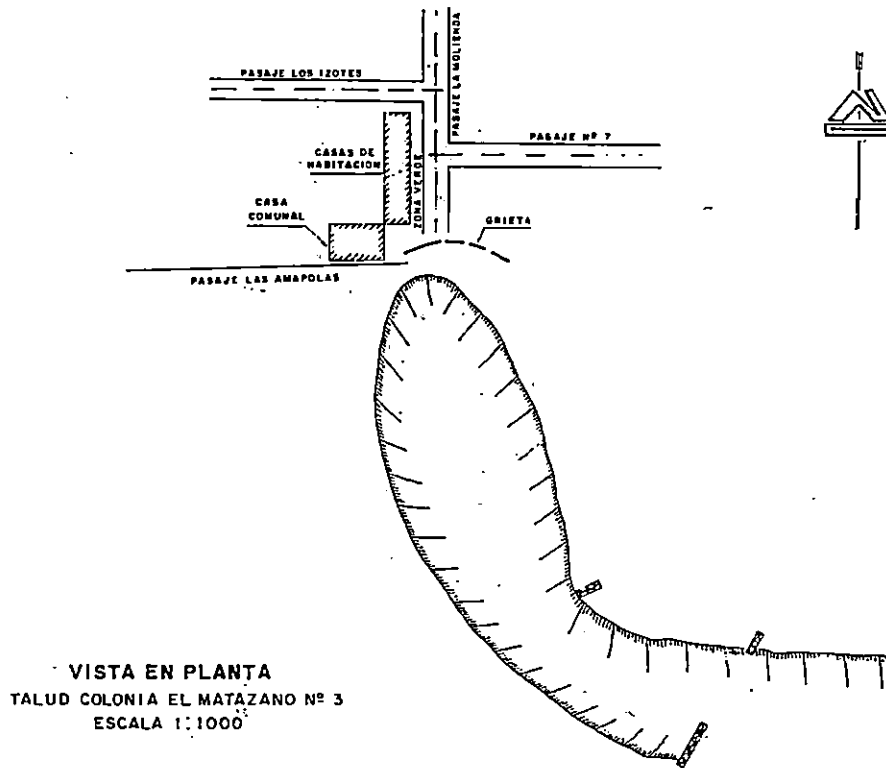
Vista en planta del deslizamiento Colonia El Matazano No. 3
